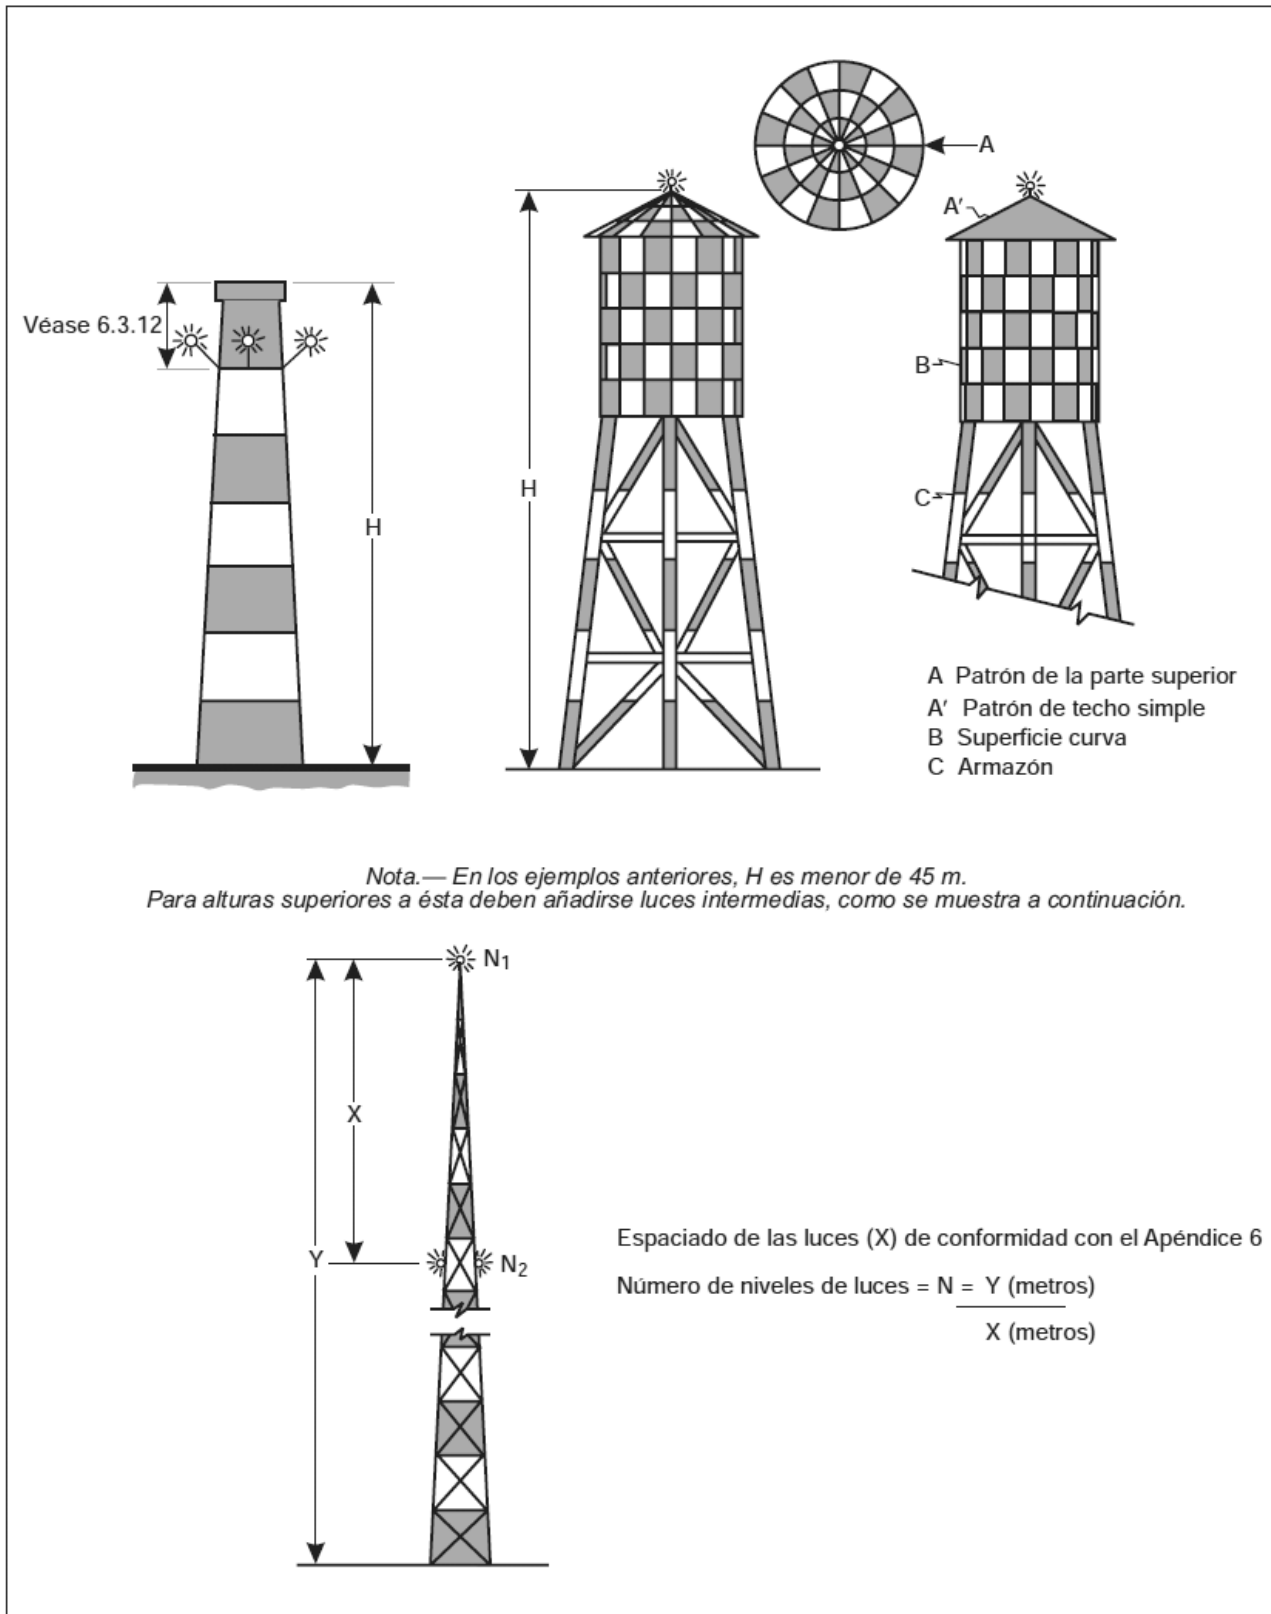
Ejemplos de señalamiento e iluminación de estructuras elevadas
